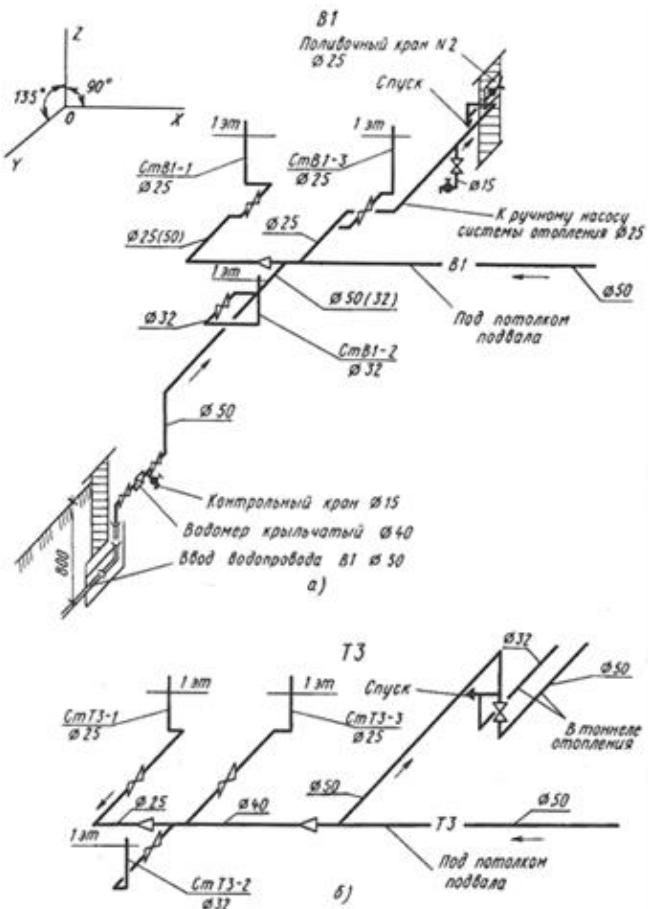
Аксонометрическая схема трубопроводов: а) водопровода; б) горячего водоснабжения
